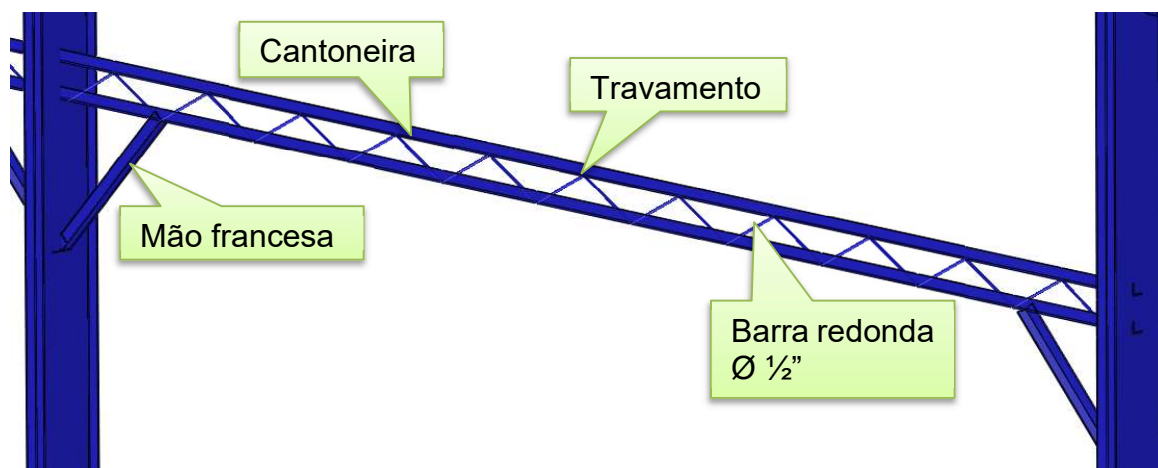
TRAVAMENTO ENTRE PÓRTICOS
